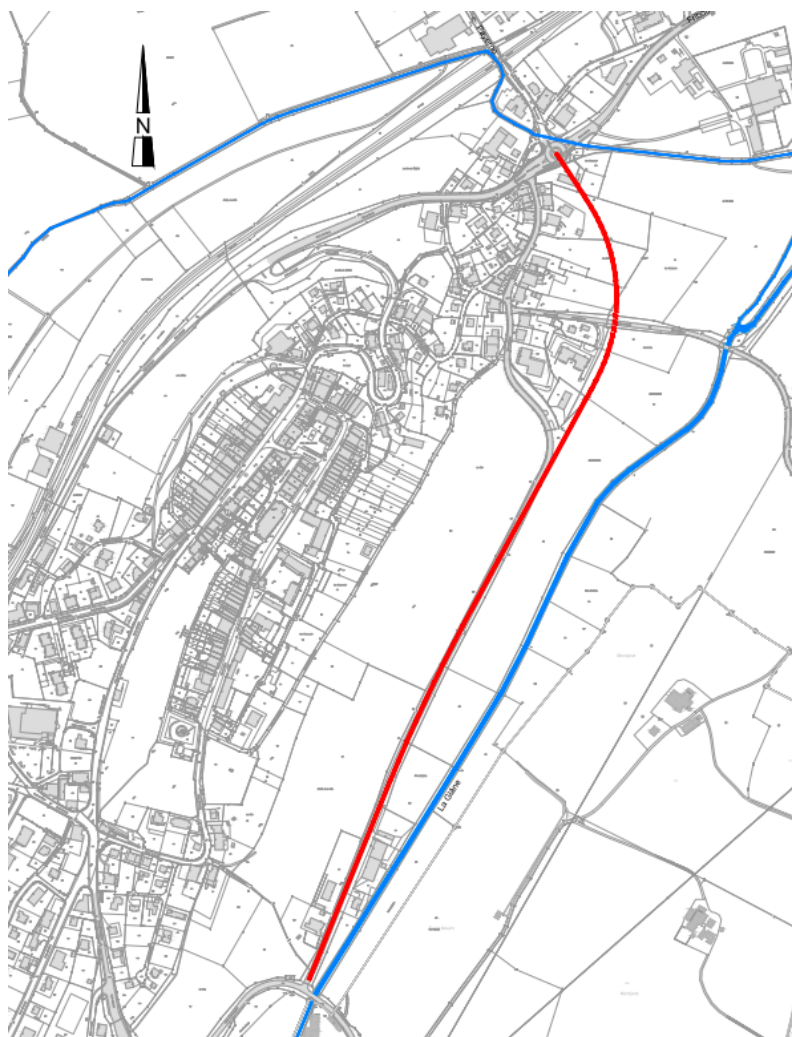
Plan du tronçon Nord - Route de Chavannes à Giratoire de la Parqueterie
